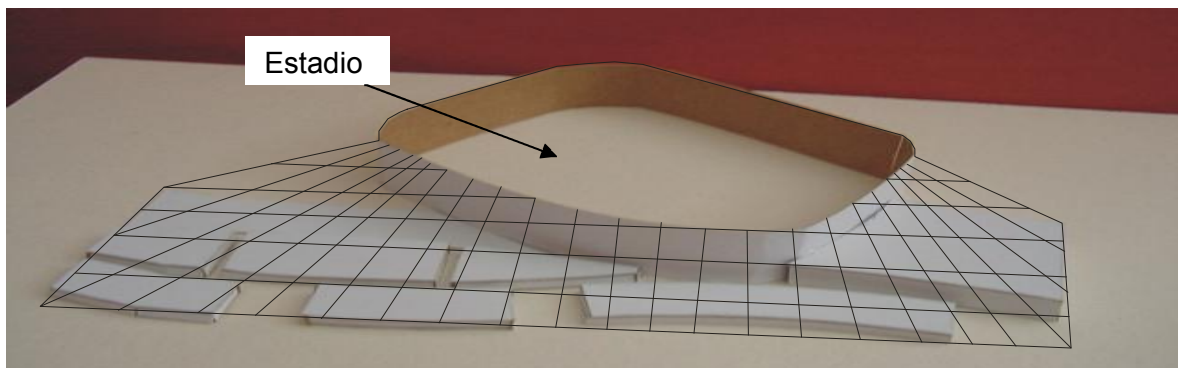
Vista aérea de la maqueta preliminar del plan maestro
